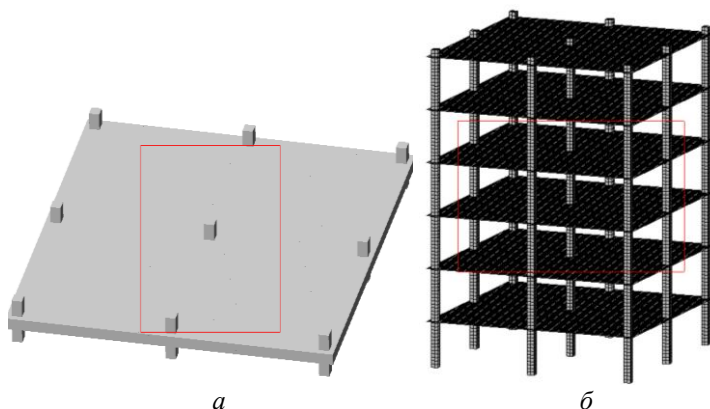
Общий вид фрагмента: *а* – перекрытия; *б* – здания
